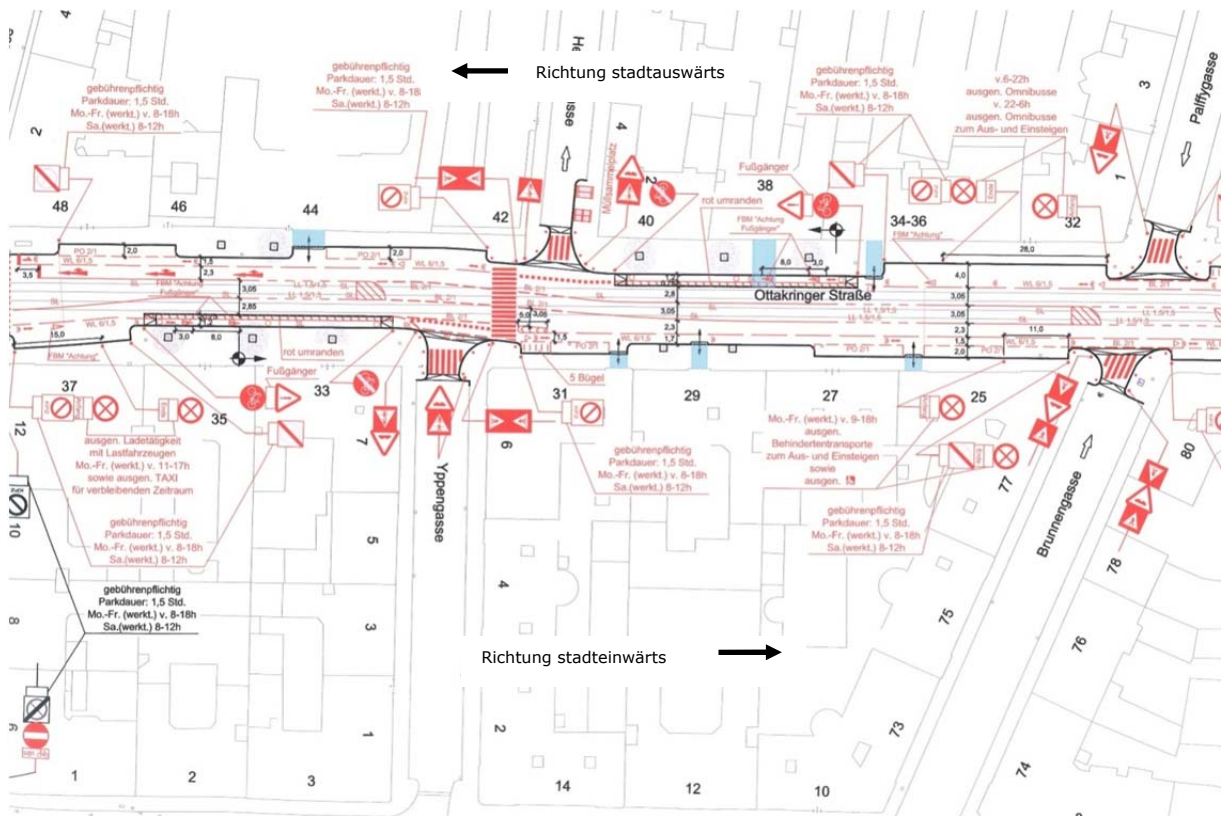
Lageplan Haltestelle Bergsteiggasse.
